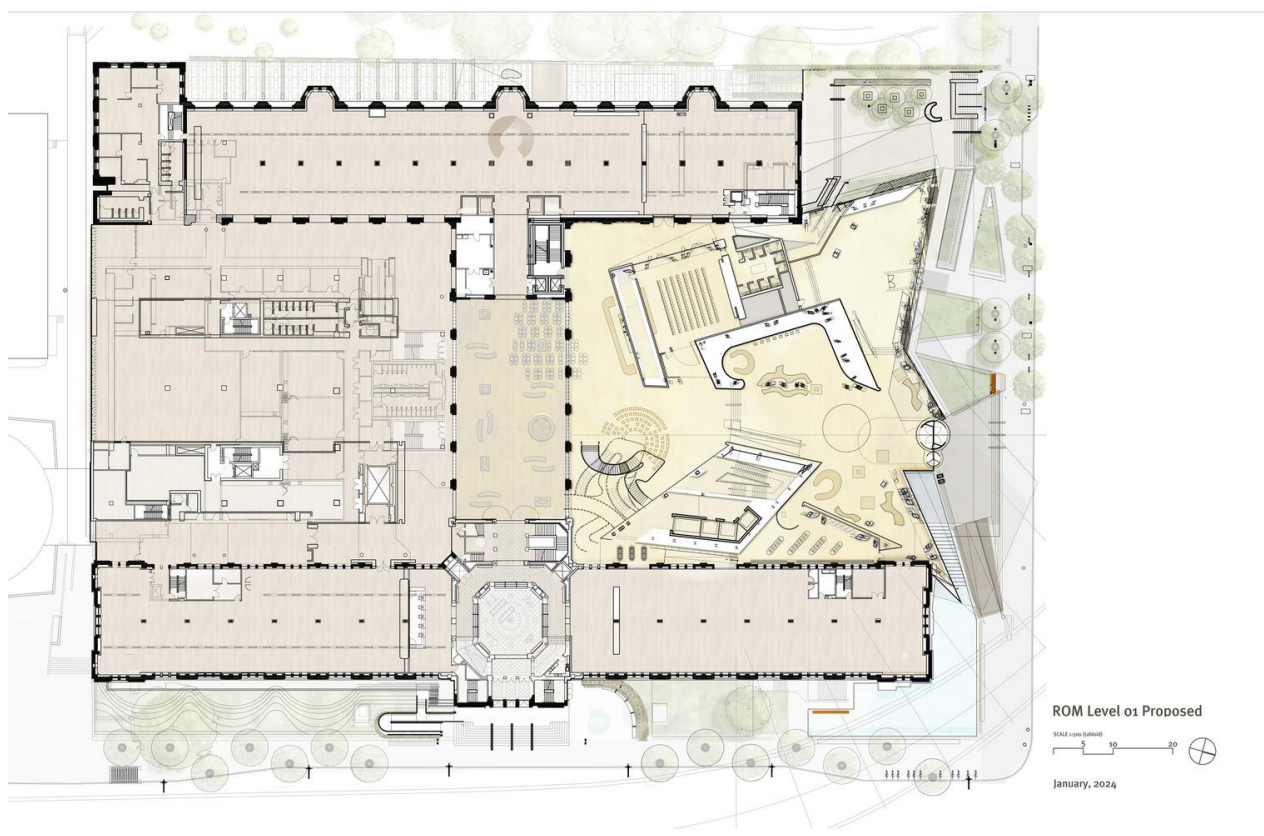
План 1-го поверху будівлі музею ROM [4]
